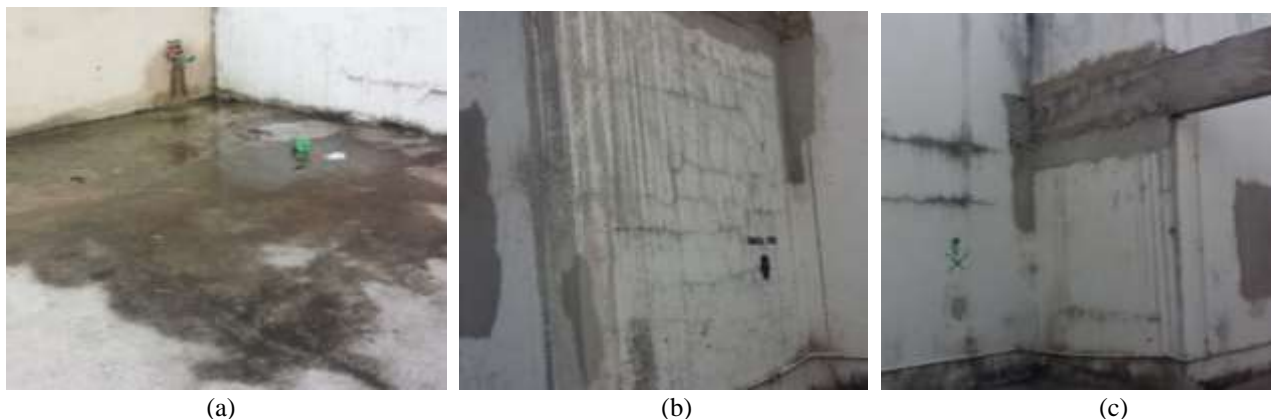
Área descoberta no pavimento superiores - (a) Empoçamento, (b) Mapeamento de fissura, (c) Machamentos e fissuras.
